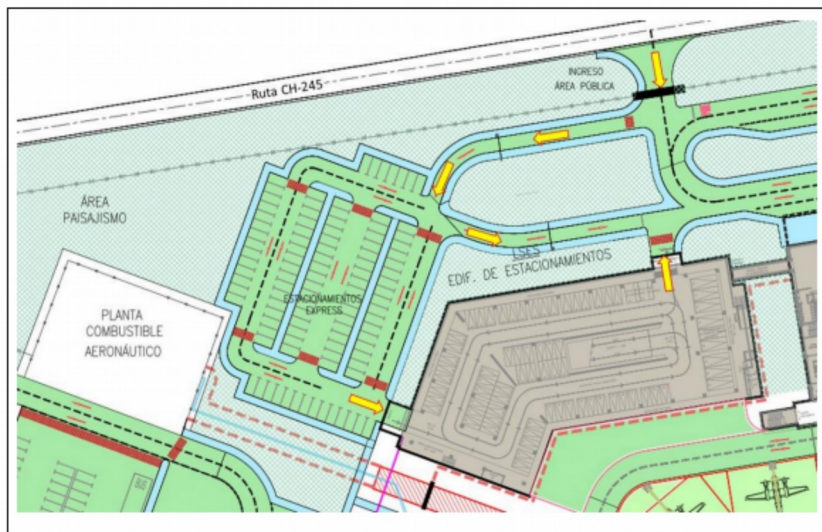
Plano Edificio de Estacionamientos de Vehículos. Primer Piso
